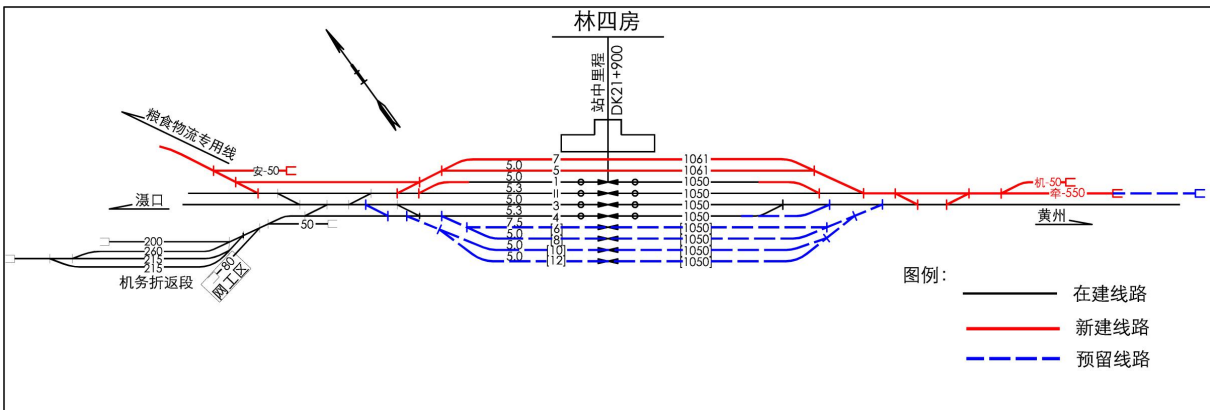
林四房站西咽喉北侧接轨平面布置示意图
